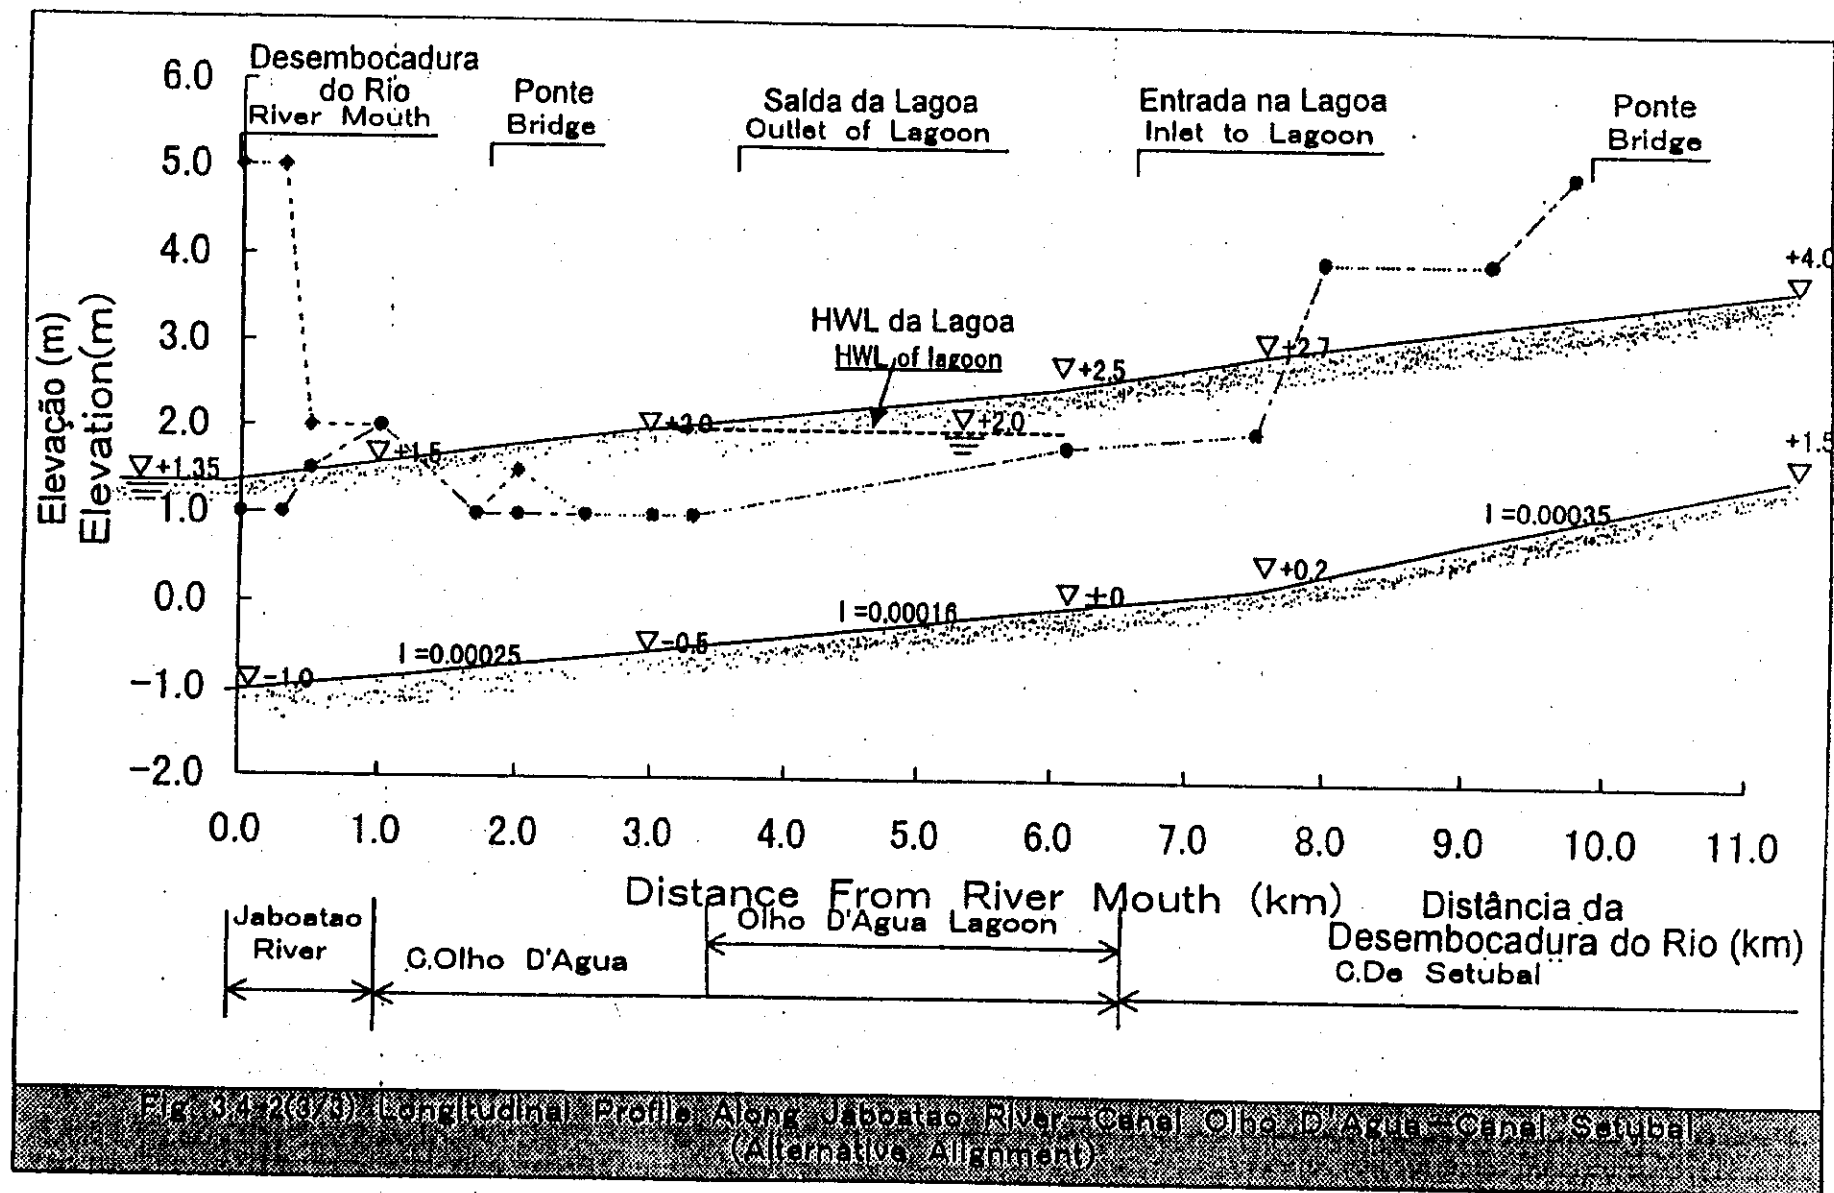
(3/3) Corte Longitudinal ao longo do Rio Jaboatão - Canal Olho D'Água - Canal Setúbal (Alinhamento Alternativo)
